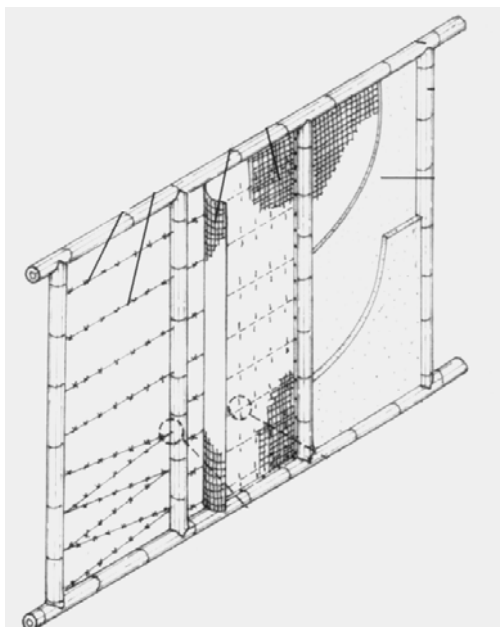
Telas de tecido grosso são aplicados nas estruturas de bambu, facilitando. A aplicação da argamassa de revestimento dos painéis (LÓPEZ, 2003, p.242).
